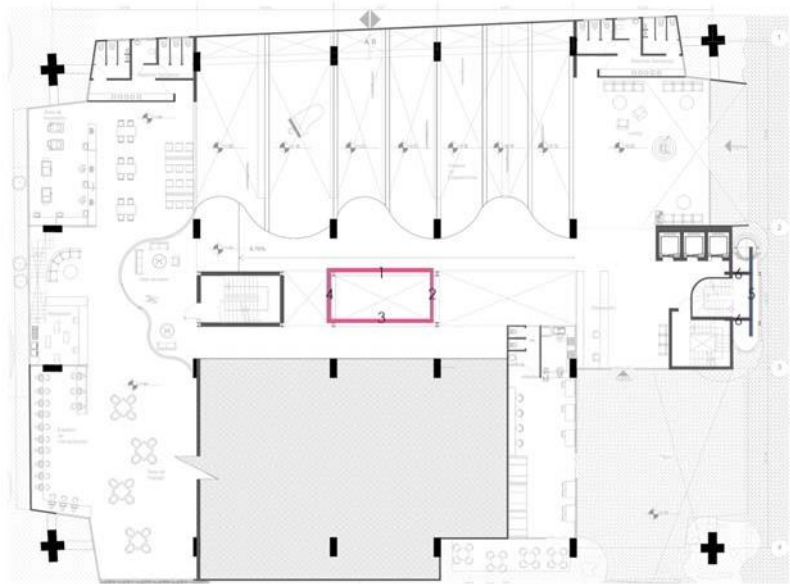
Planta Baja vigas de acero. Elaboración propia.
